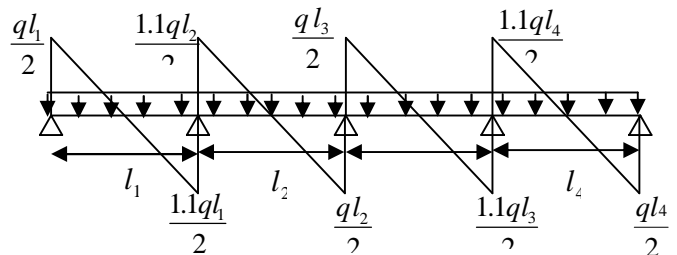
Effort tranchant d'une poutre à plus de 2 travées
